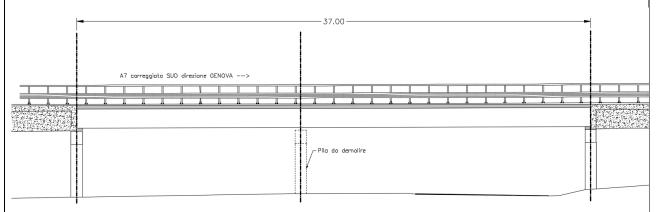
Intervento di adeguamento del viadotto VI09U nella soluzione di progetto approvato
